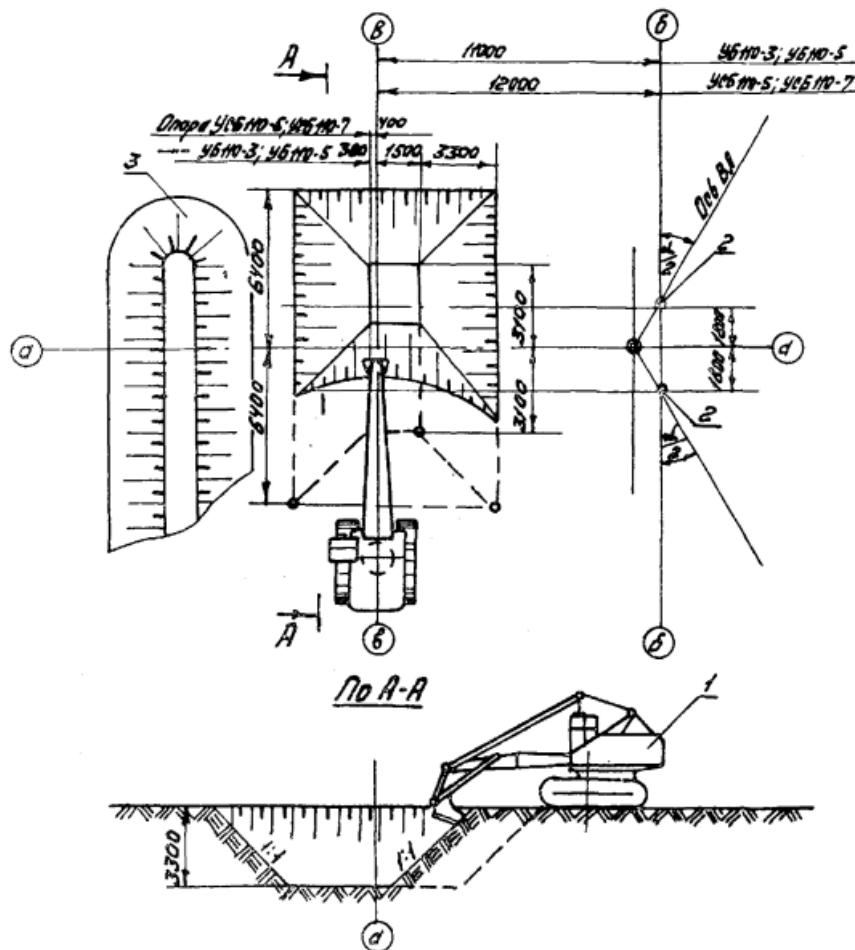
Разработка котлована под анкерные плиты для опор: УБН-3; УБН-5; УСБН-5; УСБН-7
